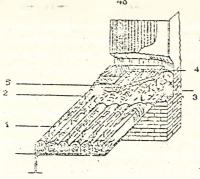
Узел реконструкции деревянного перекрытия. где: 1-деревянные бадки, 2-скобы-стержии, 3-водонепроницаемъя пленка, 4-система воздушной вентилични, 5-железобетсиная плита. 6-пол.
